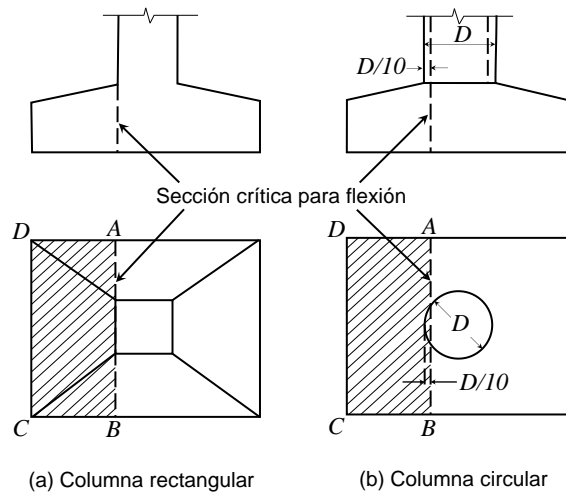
Secciones críticas para diseño por flexión en zapatas que soportan columnas de concreto
